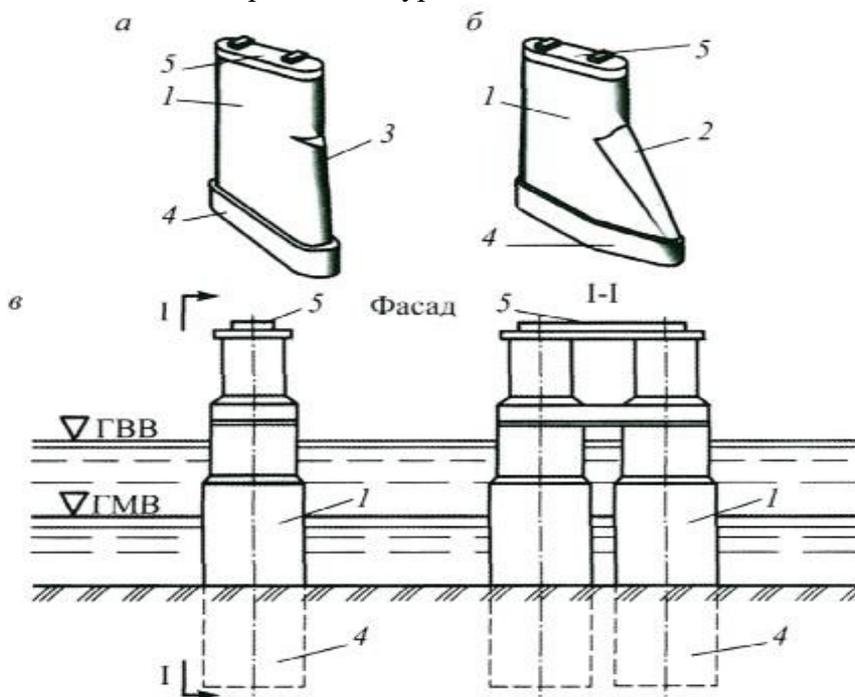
Промежуточные опоры: а - каменный (бетонный) бык с водорезом; б - каменный (бетонный) бык с ледорезом; в - трубчато-телескопическая промежуточная опора (бык); 1- тело опоры; 2- ледорез; 3 - водорез; 4 - фундамент; 5- подферменная плита
